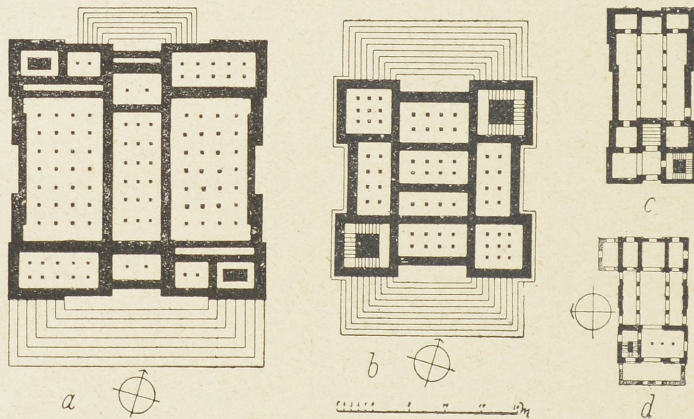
a) Enda Semon in Aksum, ergänzter Grundriss. b) Enda Mikael in Aksum, ergänzter Grundriss. c) Grabkirche des Königs Kaleb bei Aksum, ergänzter Grundriss. d) Klosterkirche Debra Damo (urspr. Bau schwarz, Anbauten geschrafft).
